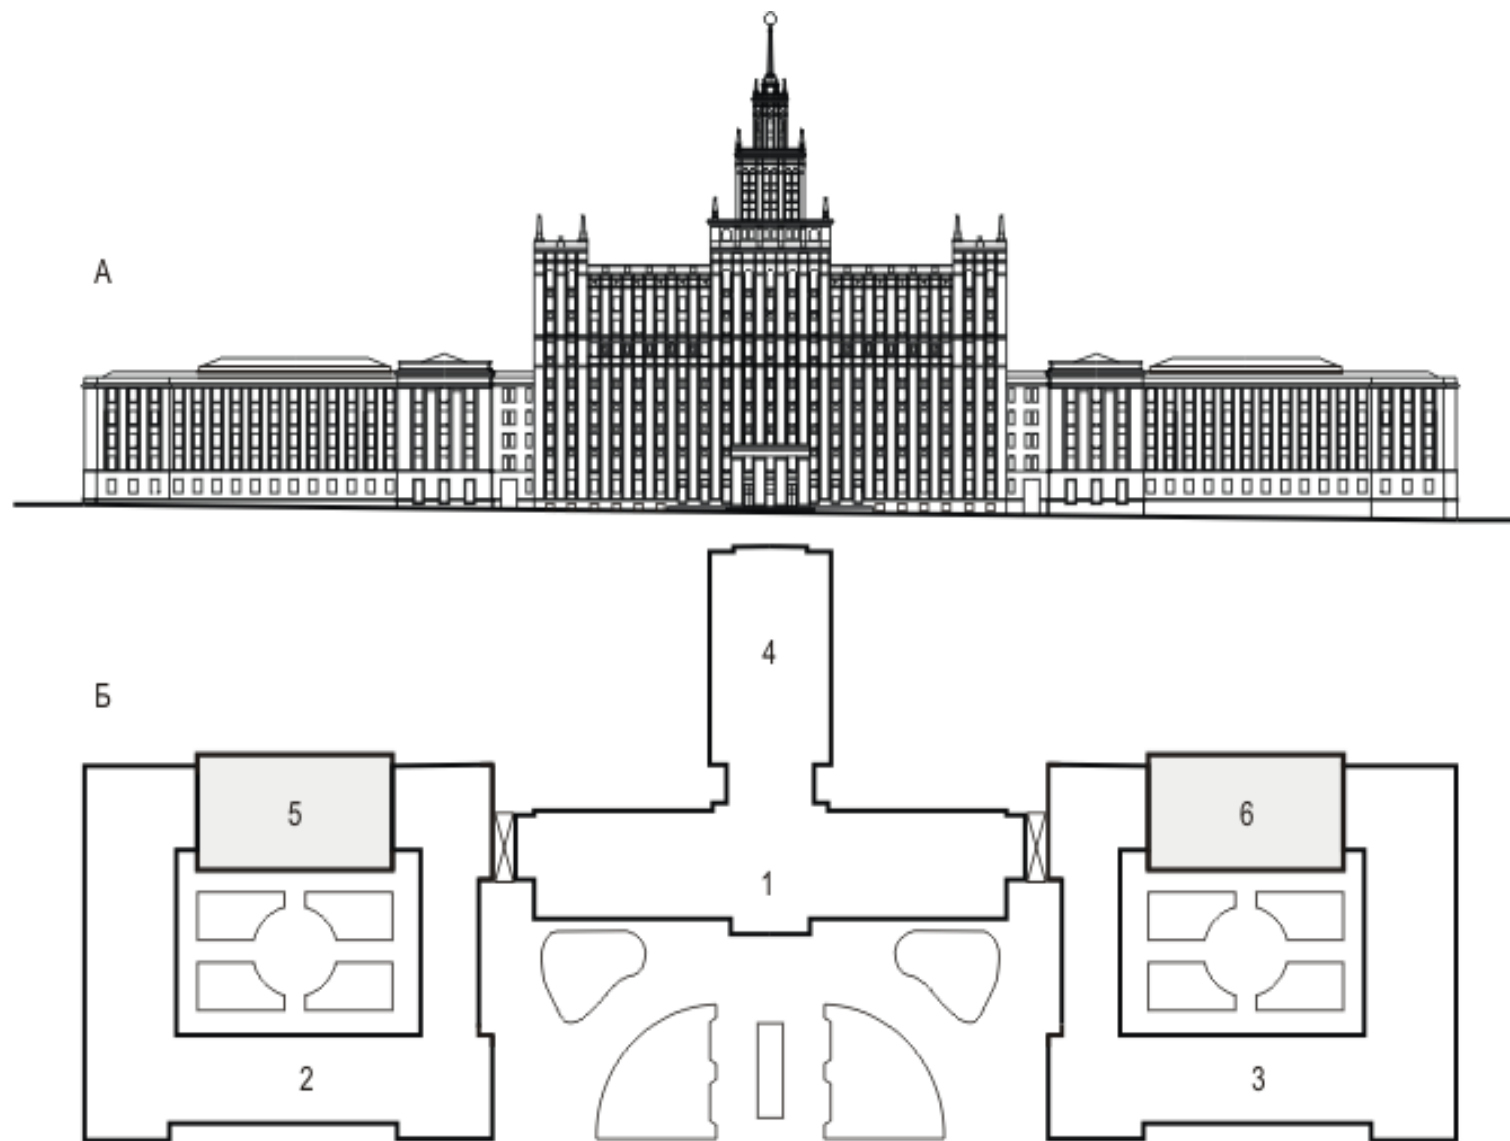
Проект южного фасада (А) и схема генплана (Б) главного корпуса университета по окончательному варианту с 10 – этажной центральной частью, башней и шпилем: 1 – центральная часть; 2 – западное крыло с возводимым пристроем 5; 3 – восточное крыло с пристроем (перспектива – 6); 4 – пристроенный блок библиотеки и актового зала (2006 г., ЮУрГУ)
